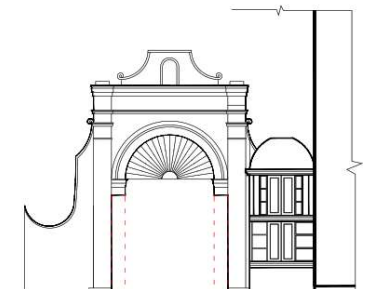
pilastras mutiladas del arco poniente del atrio, en línea punteada se representa las pilastras faltantes. Autor: SLF
